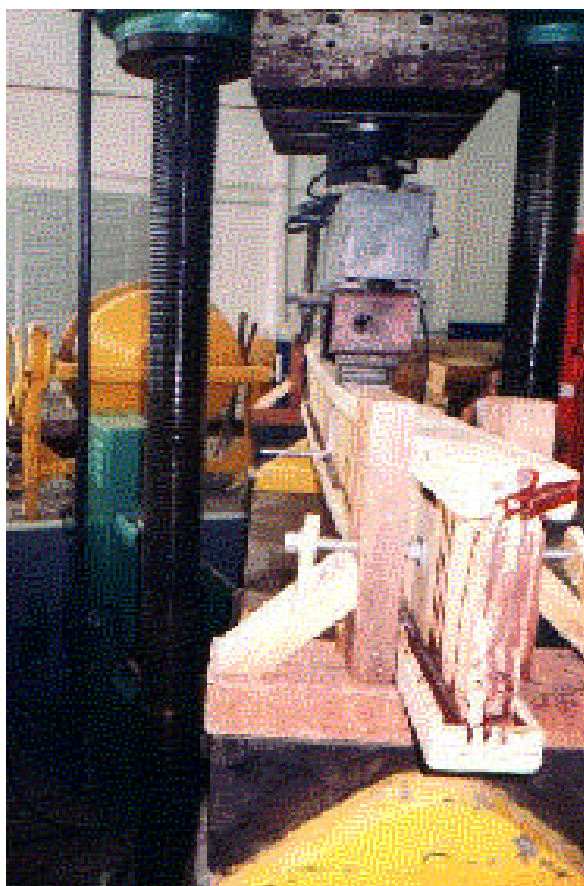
Ruptura da Viga Mesa LVL – V3 – Compressão da Mesa Superior
